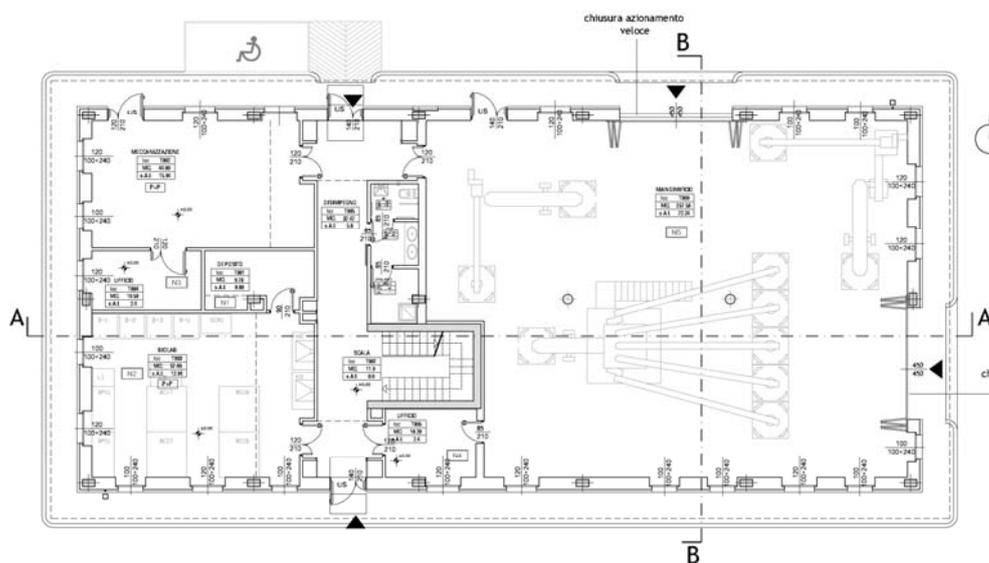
Mangimificio - Pianta piano terra - fuori scala
